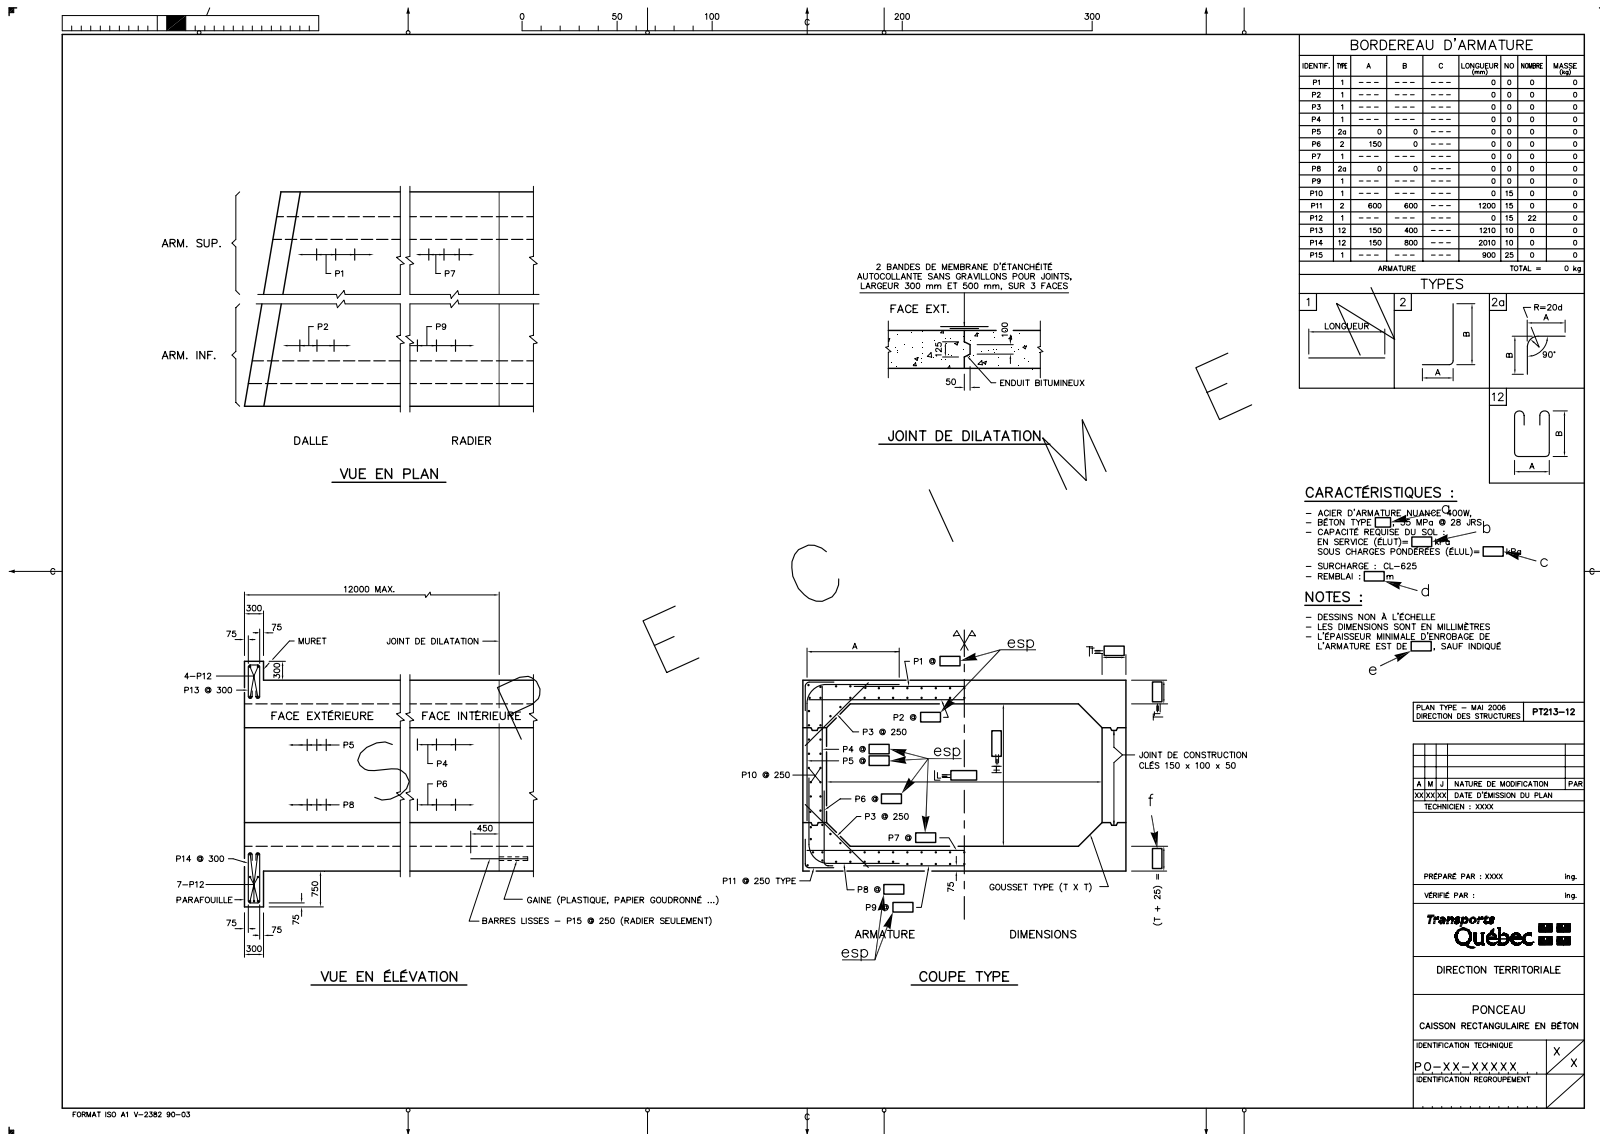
Ponceau rectangulaire en béton armé – Plan type PT213-12
